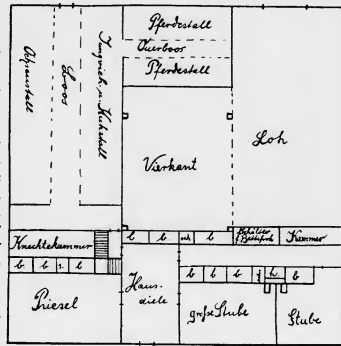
Grundriss eines Eiderstedter Hau-barges (aus Lüttgens, tab. 38).
